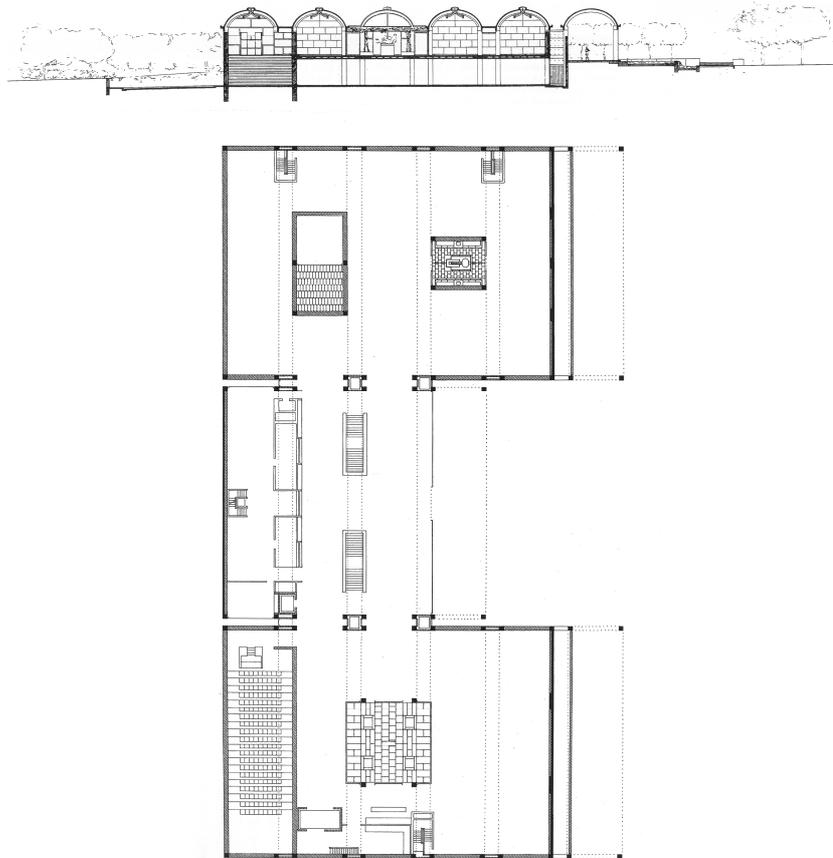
Planta y sección del Museo Kimbell en Fort Worth(1972) de Louis I. Kahn.
